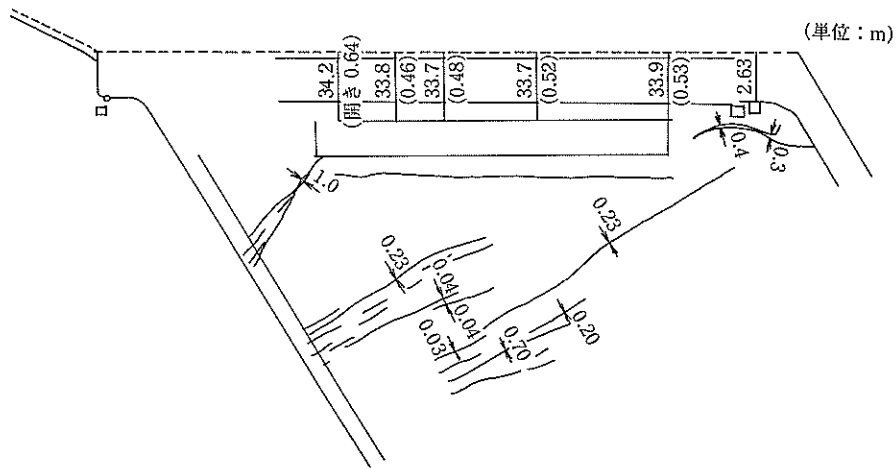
(3) 外港-13m岸壁被災平面図⁹⁾
